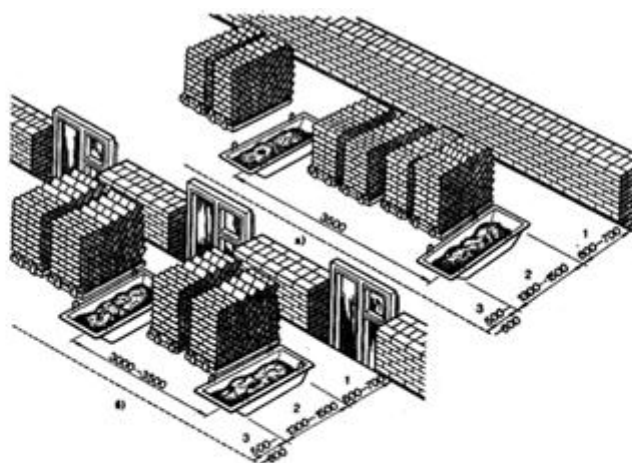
Схема организации каменных работ: а – при кладке сплошных стен; б – при кладке стен с проемами; зоны: 1 – рабочая, 2 – материалов, 3 - транспортная
